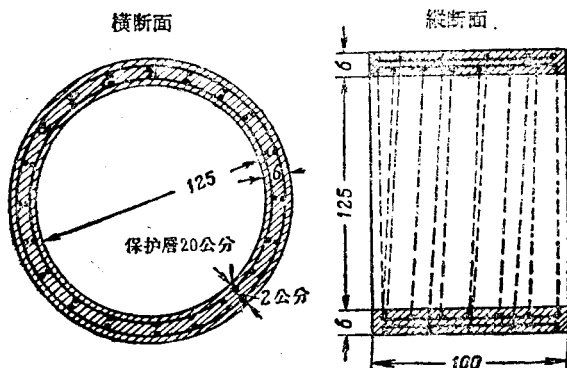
圆形钢筋混凝土管节的钢筋配置情形
